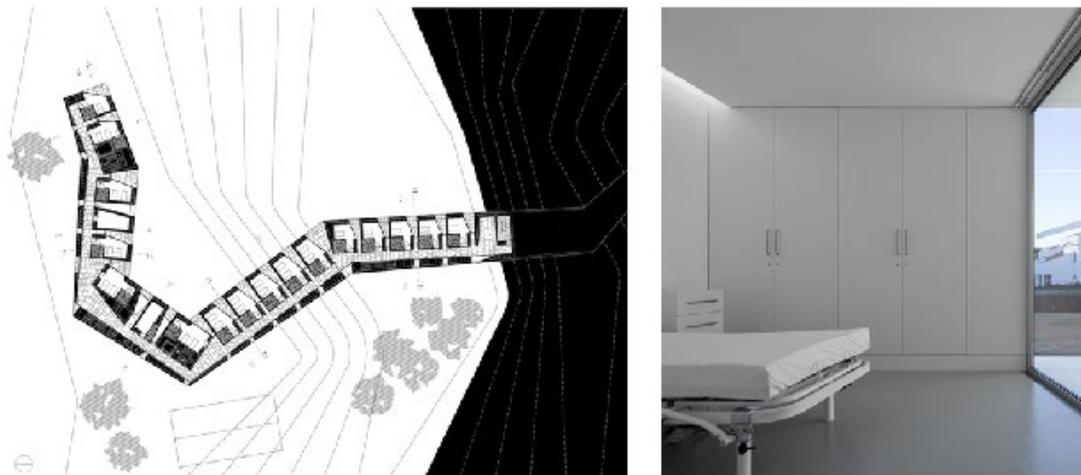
Planta primera y habitación privada con terraza. (Fuente: Archdaily, 2013)
